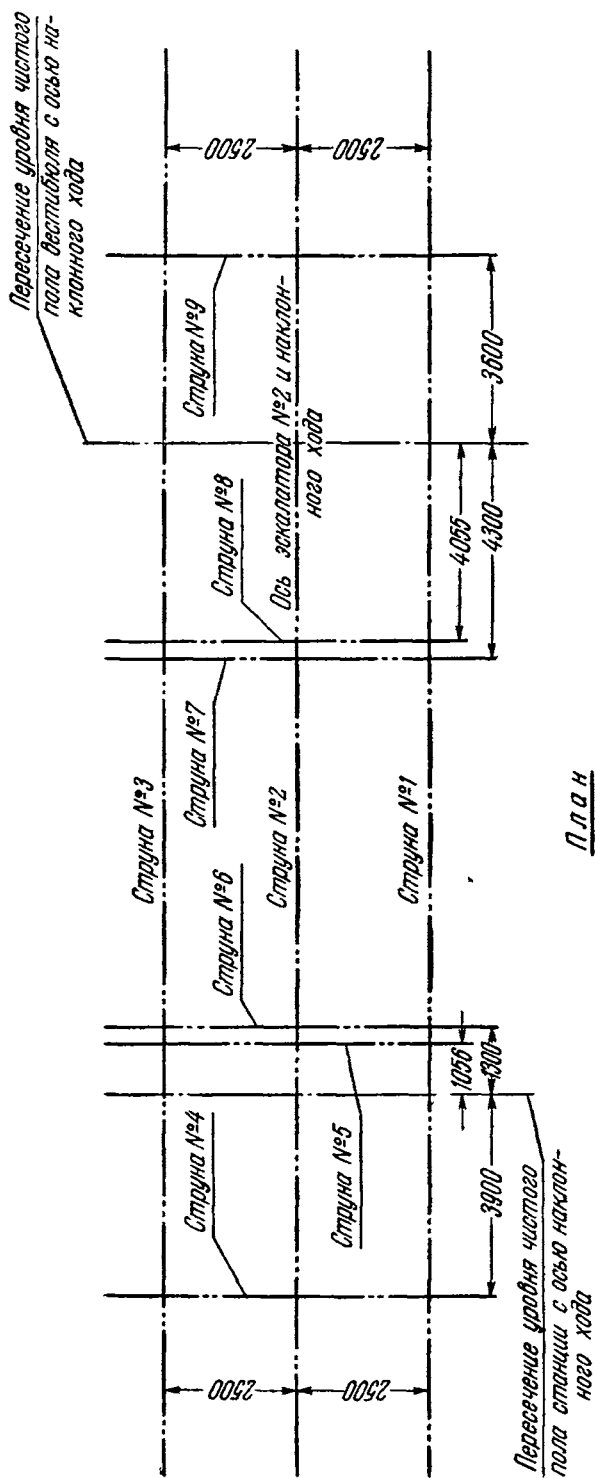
Схема закрепления струн при монтаже эскалаторов (план)
